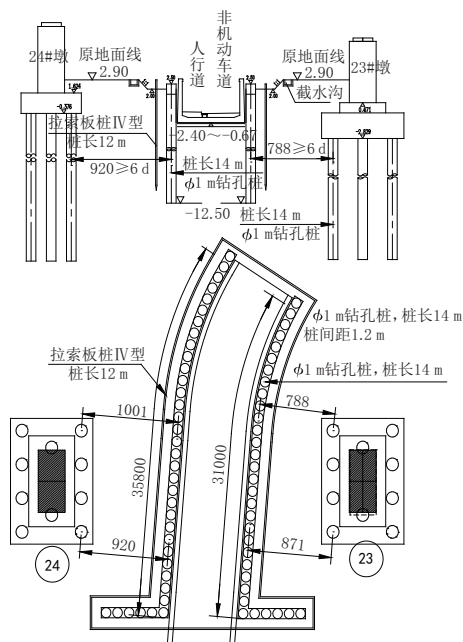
南京侧下穿沪宁高铁基坑平面布置图(单位:mm)
